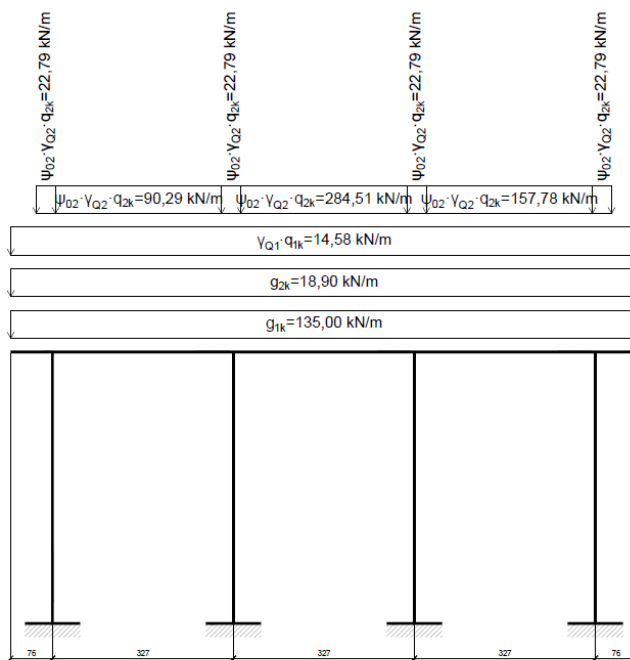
Schema statico della pila della US2 allo stato di progetto in combinazione SLU6.
